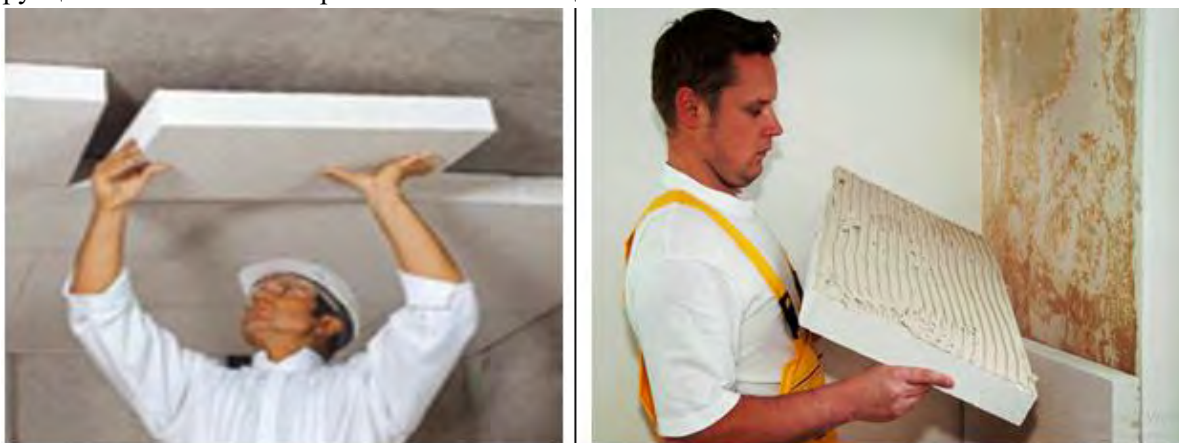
Фрагмент використання теплоізоляційного газобетону для внутрішнього утеплення будівель.
